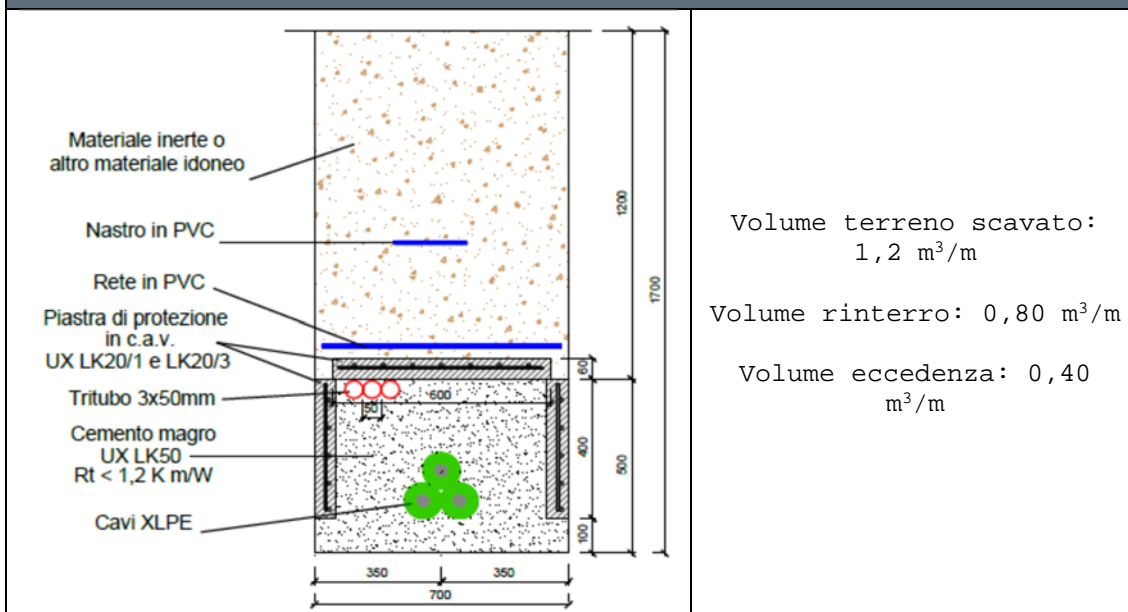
Sezione di posa del cavo interrato in sede stradale
